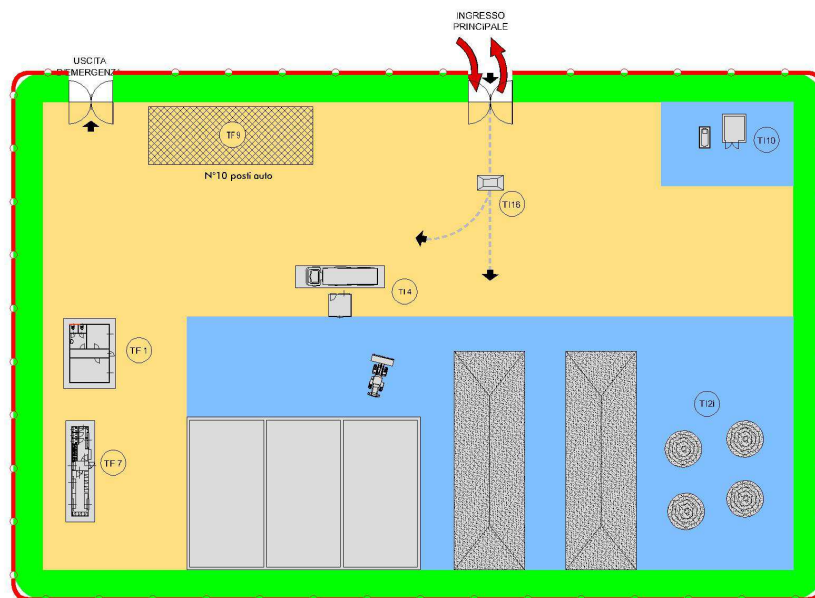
LAYOUT AREE DI CANTIERE OPERATIVE
